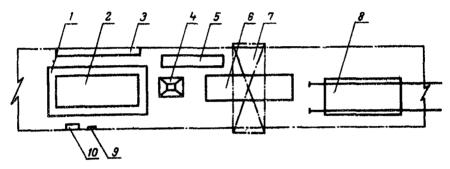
Изготовление предварительно напряженных плит перекрытия типа  $\Pi$ HOC: l — пропарочная камера; 2 — форма; 3 — установка для электронагрева стержней; 4 — бадья для бетона; 5 — место складирования арматурных изделий; 6 — зона охлаждения изделий; 7 — мостовой кран; 8 — грузовая самоходная тележка; 9 — электросварочный трансформатор; 10 — трансформатор установки для нагрева стержней
